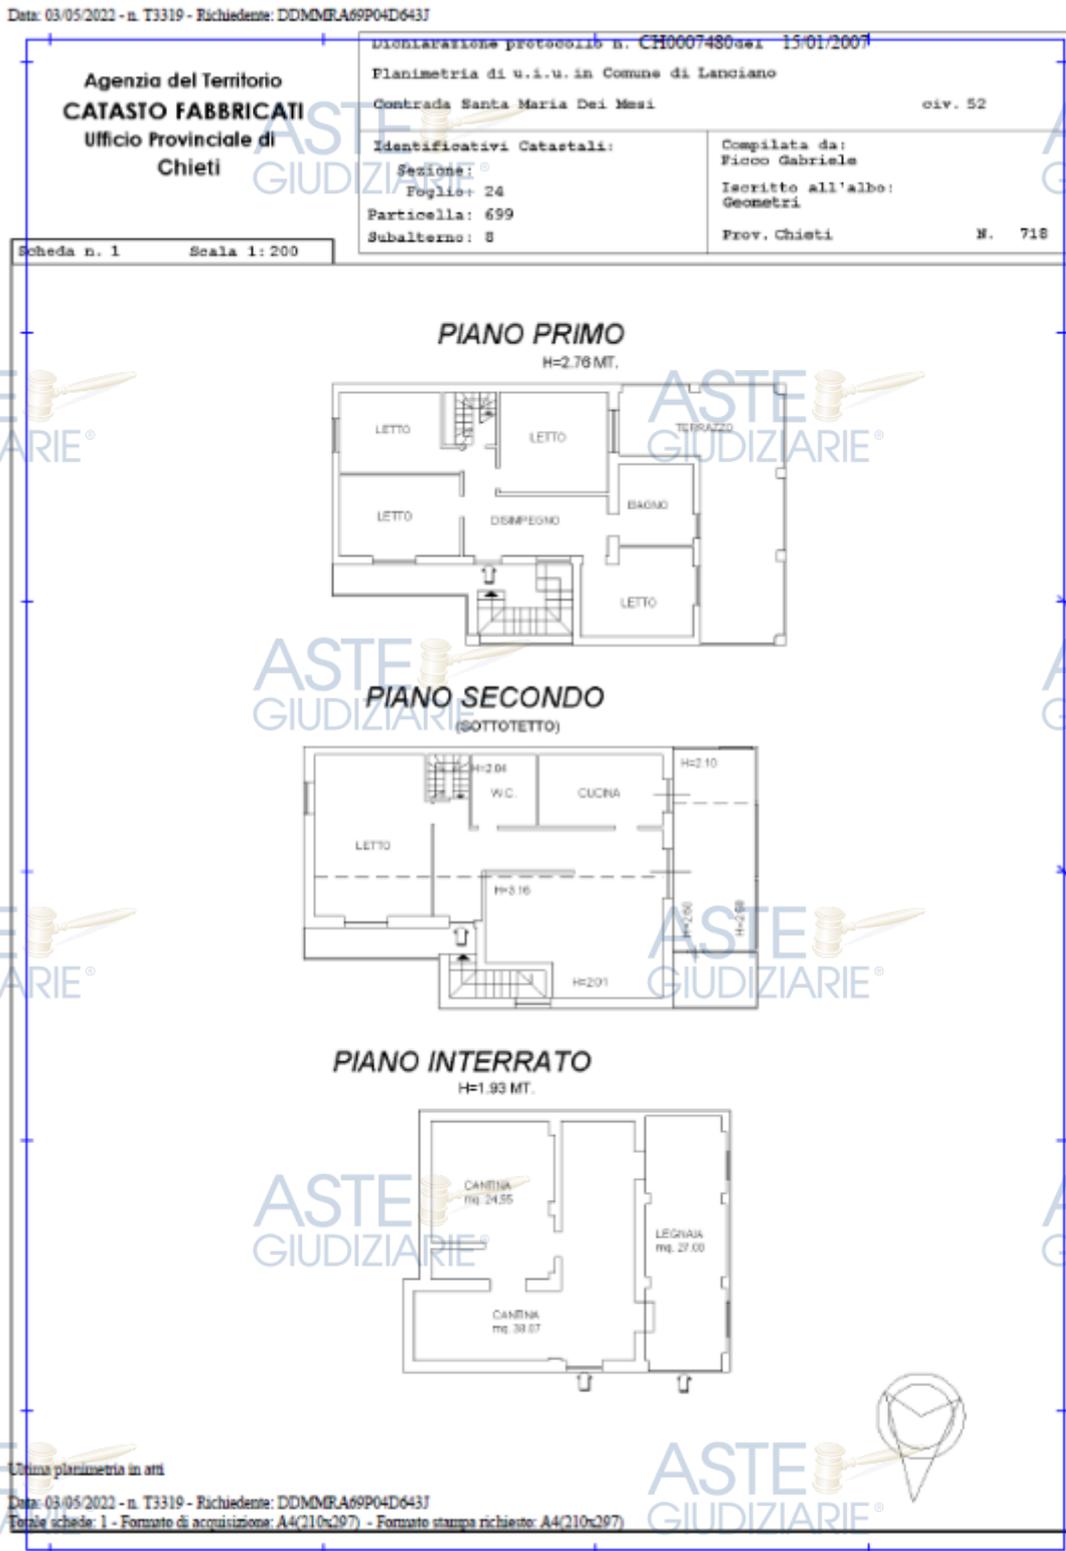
Planimetria Catastale presente agli atti e relativa al Subalterno 8 Piano interrato, primo e secondo.
